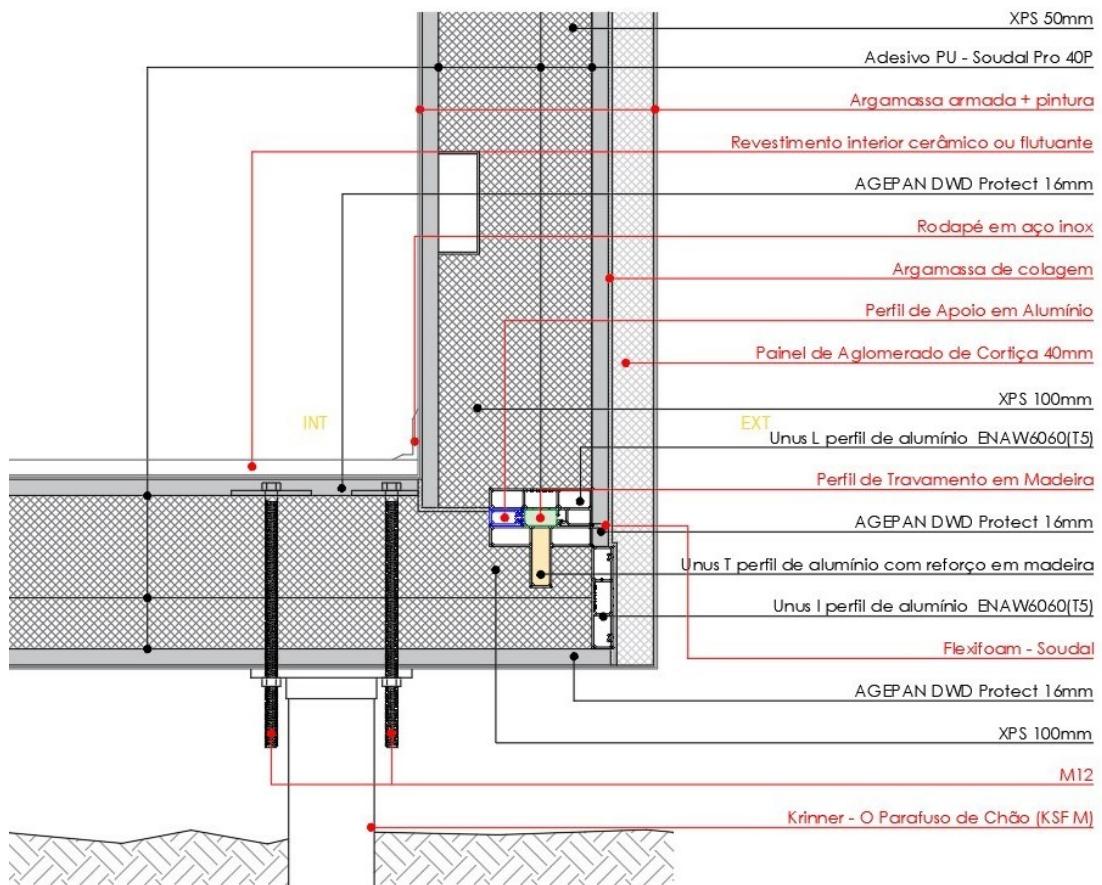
Pormenor construtivo de ligação de fundação em estacaria, com piso e parede.
